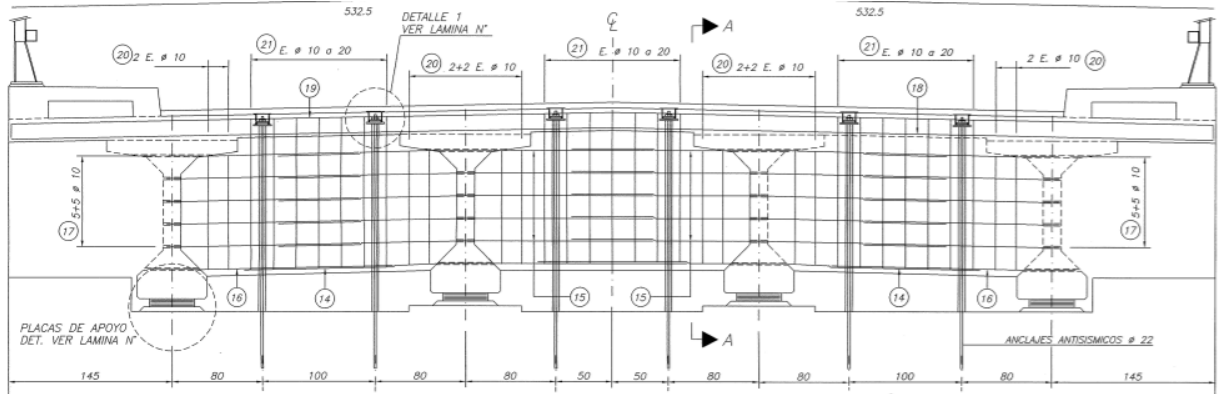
Detalle de travesaño y barras sísmicas de tablero. Planos Puente MOP [53].
